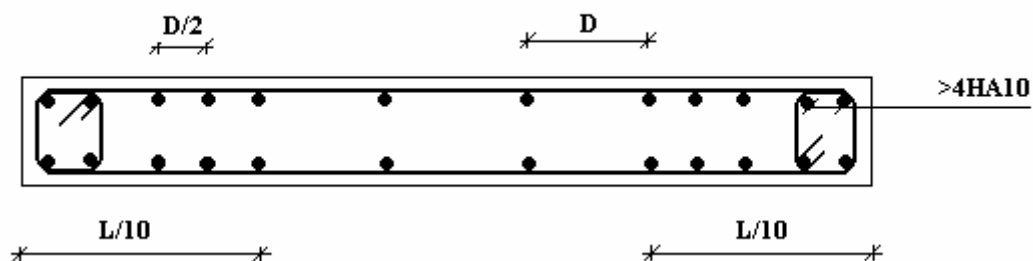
Disposition des armatures verticales dans les voiles.
